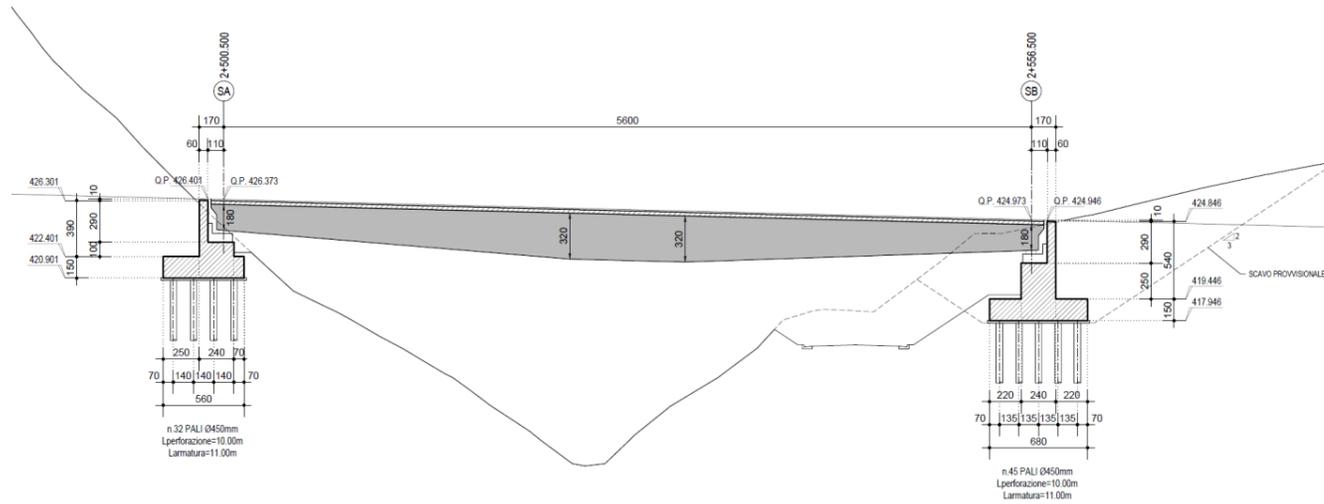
Sezione longitudinale lungo asse tracciamento
